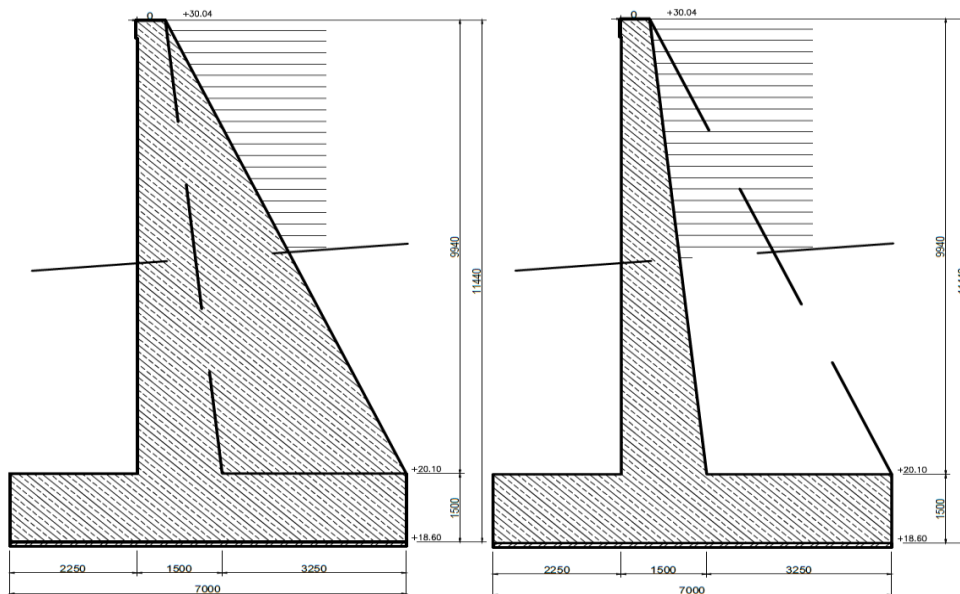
Detail konstruksi dinding Penahan Tanah tipe B
